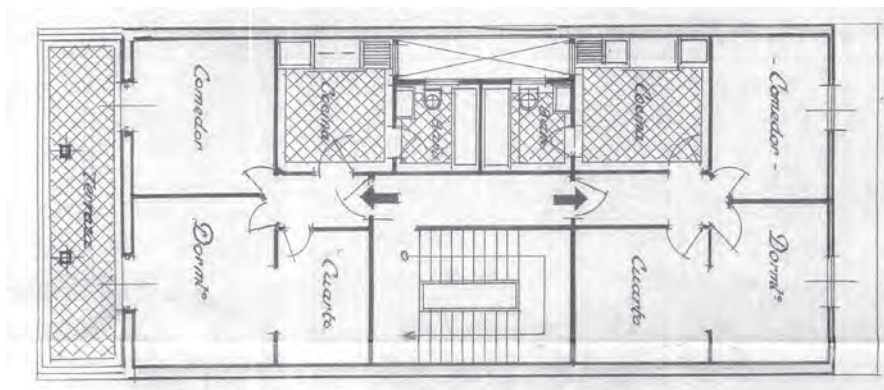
37. PLANTA DE DISTRIBUCIÓN
